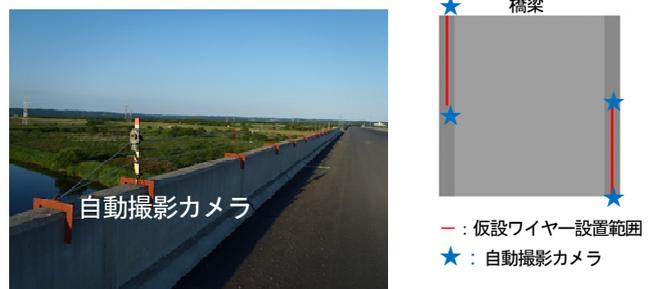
橋梁での仮設ワイヤーとカメラ設置状況
